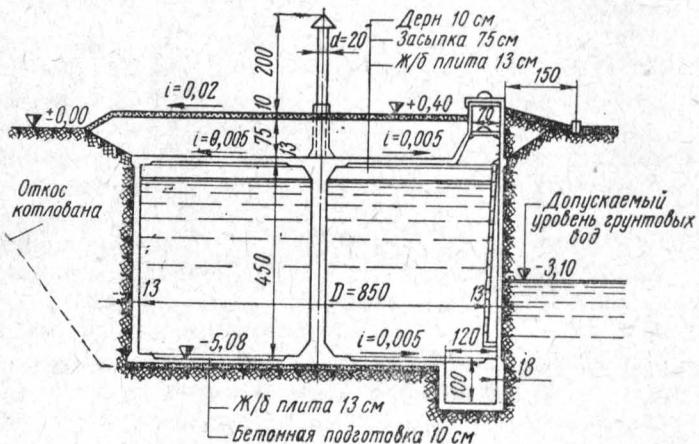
Железобетонный резервуар на 250 м³ для сырых грунтов.
